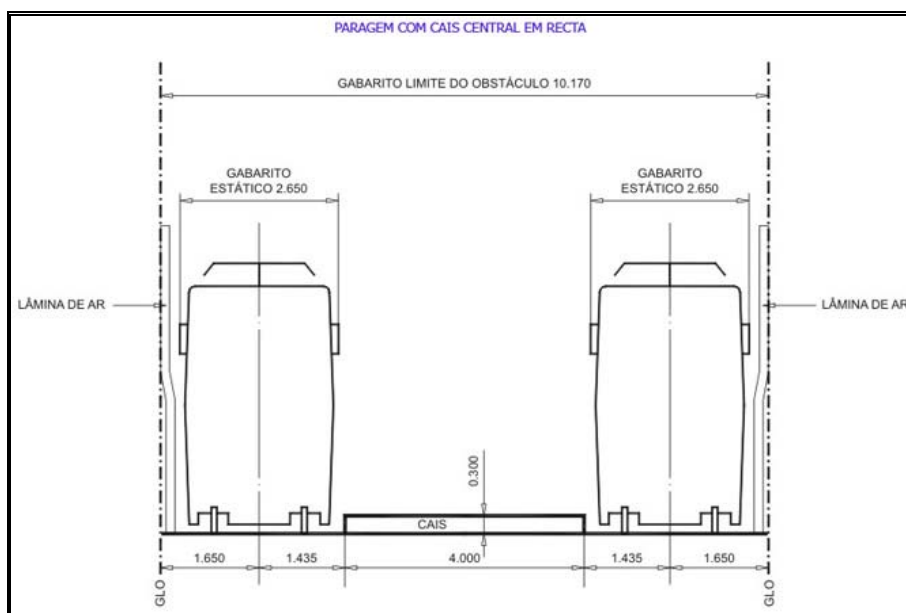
Perfil Transversal Tipo com Cais Central
